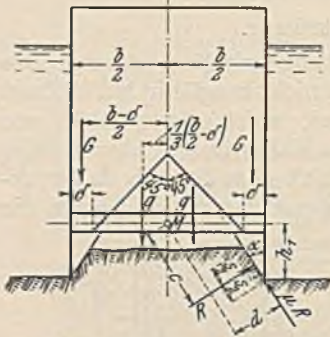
Berechnung der Deckenträger der Druckkasten.
